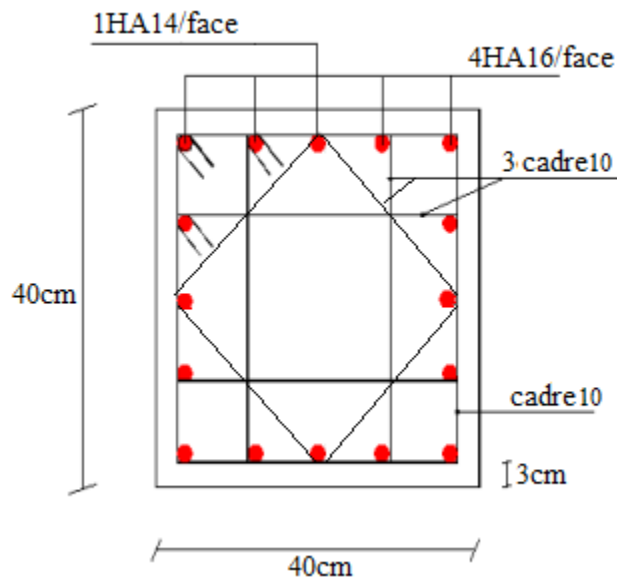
Schéma de ferraillage poteaux 8^{ème} étage+9^{ème} étage
